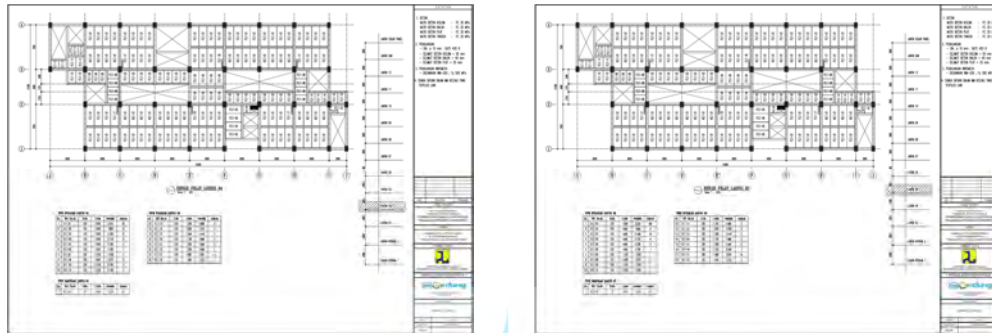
11 Detail struktur kolom lantai 11 dan 12
